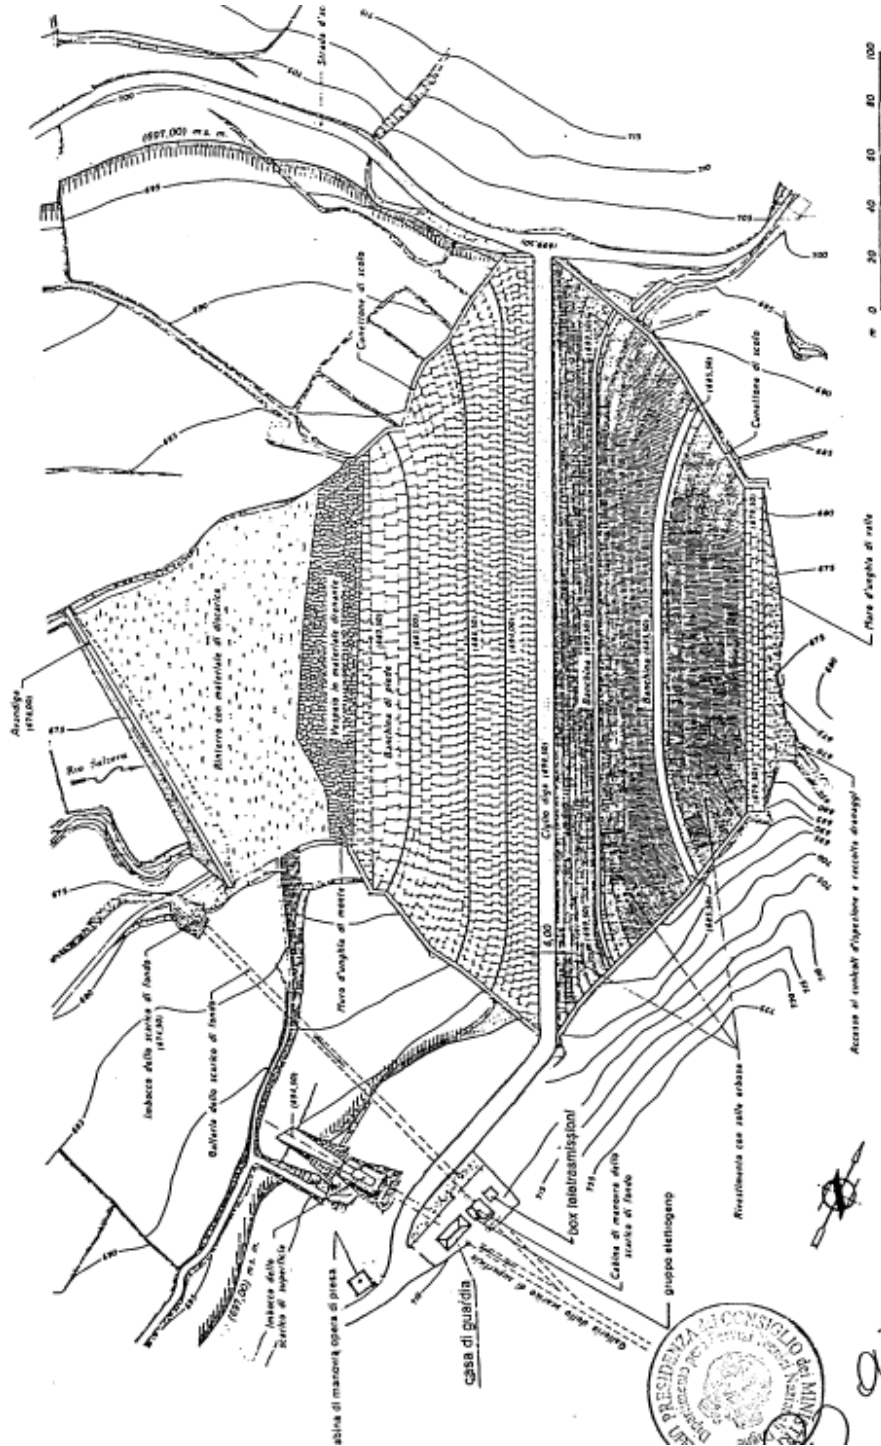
Diga di Castel San Vincenzo. Planimetria
